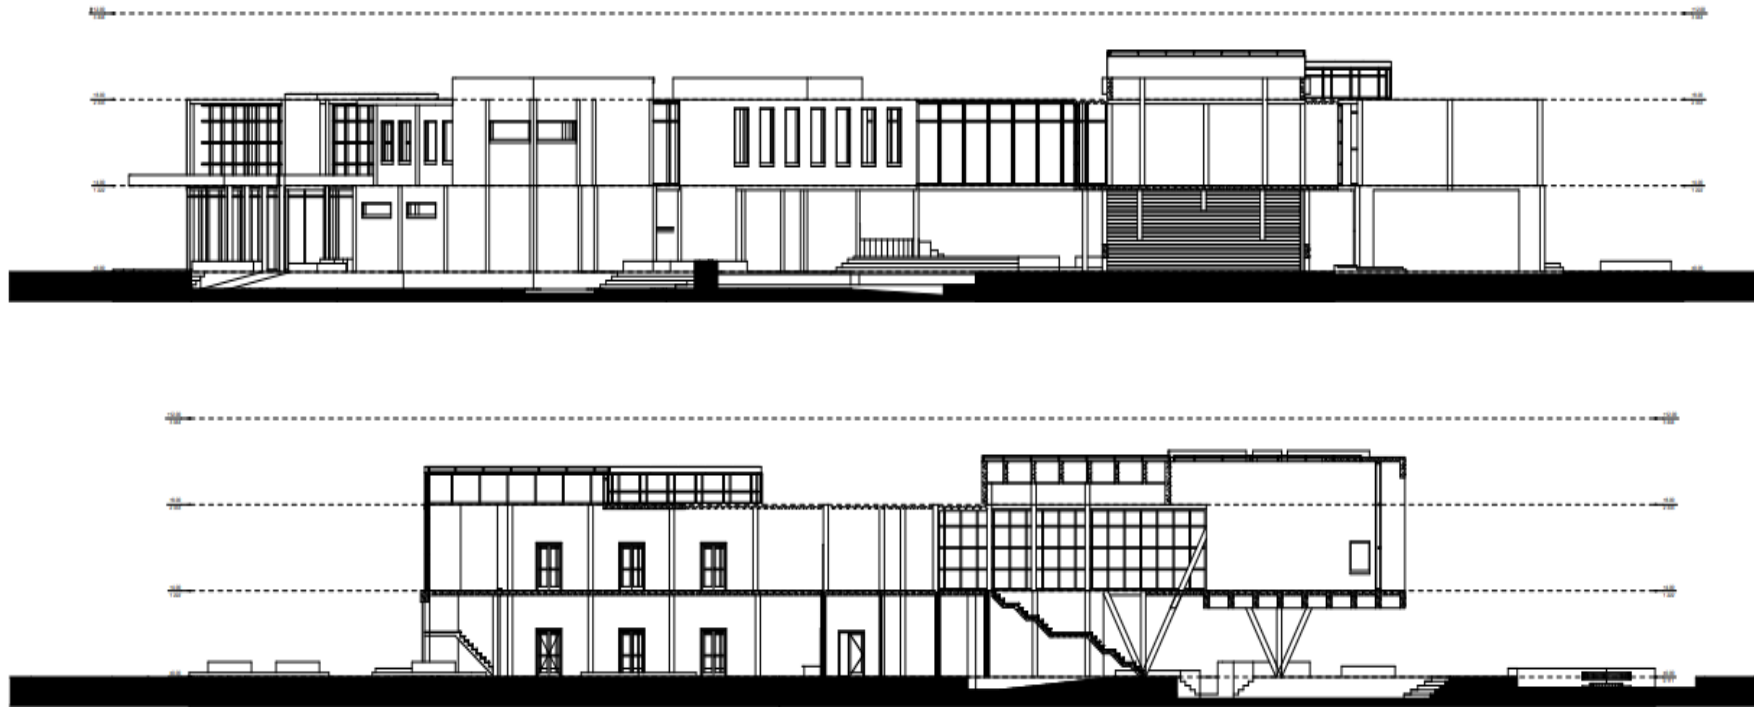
Primera Vista – Cortes generales del proyecto centro Cívico
